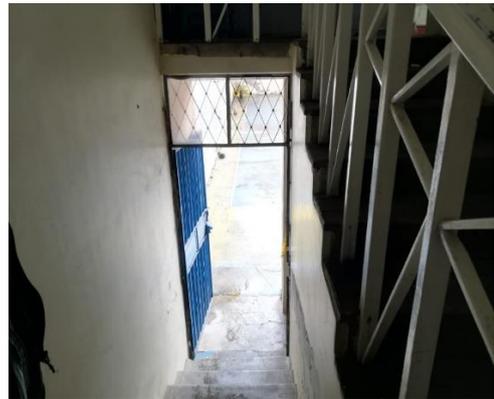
Acceso al Departamento de Dirección y Alcantarillado
